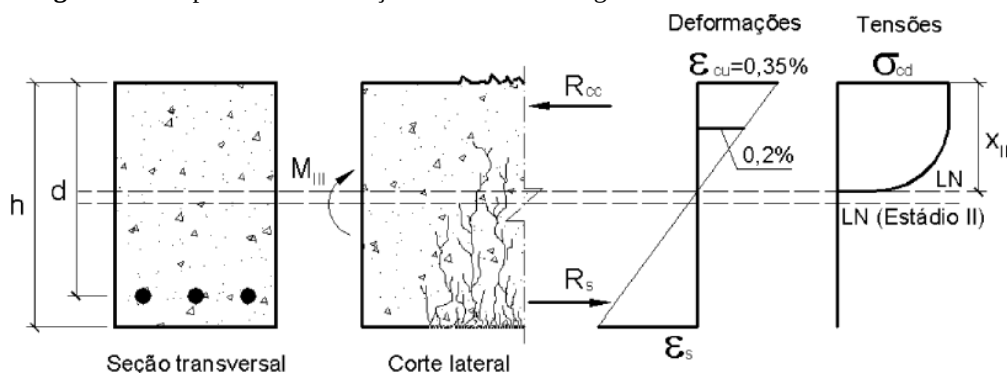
Comportamento de seção transversal de viga de concreto armado no estágio II.
